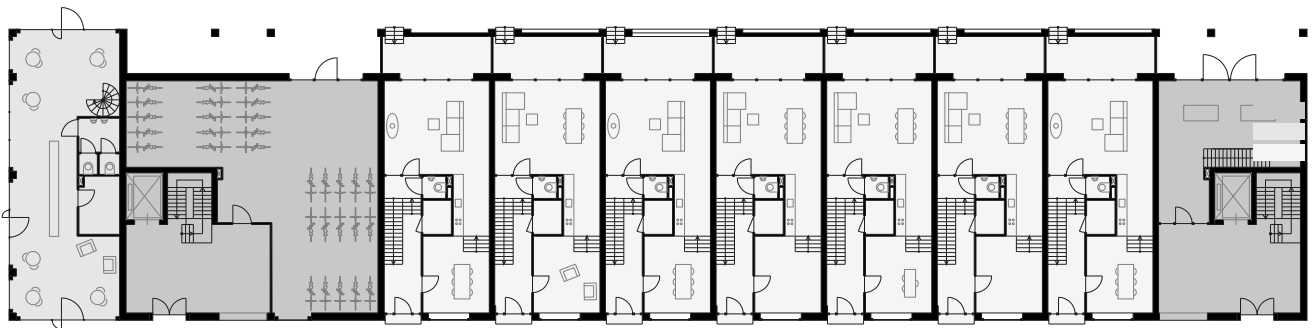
Woning 2e - 3e verdieping, uitzondering
